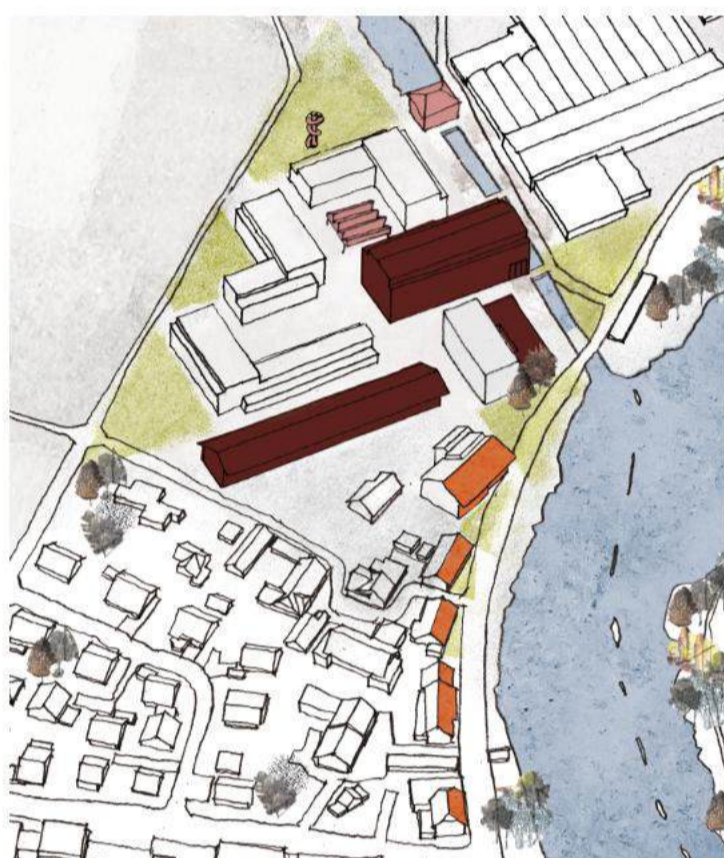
Fassaden mit Bezug zu den äusseren Freiräumen
